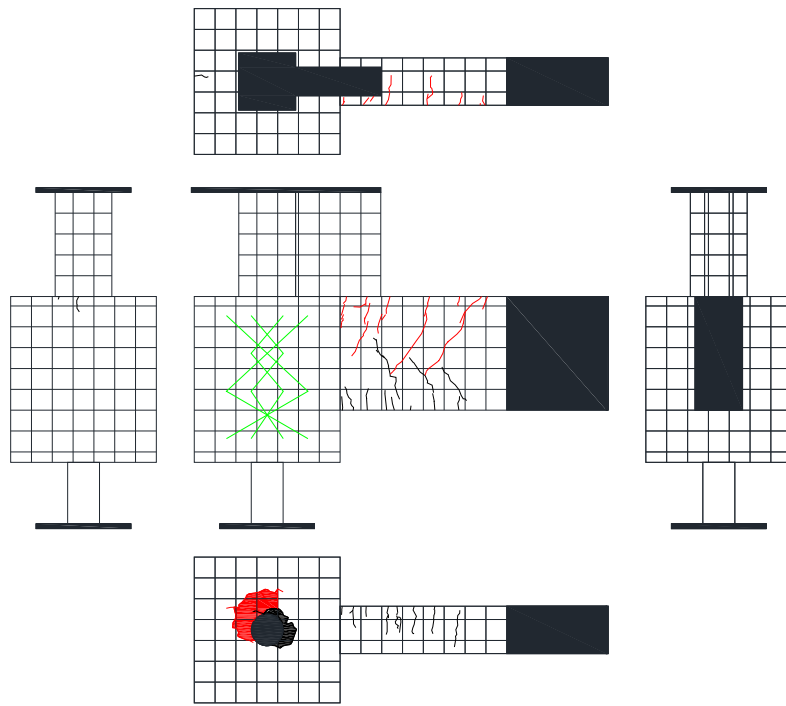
試験体 DR-3 ひび割れ状況 (8Cycle)
